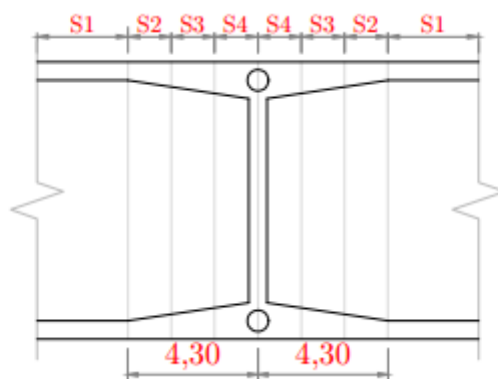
Esquema em planta da variação da secção transversal e nomações das secções
